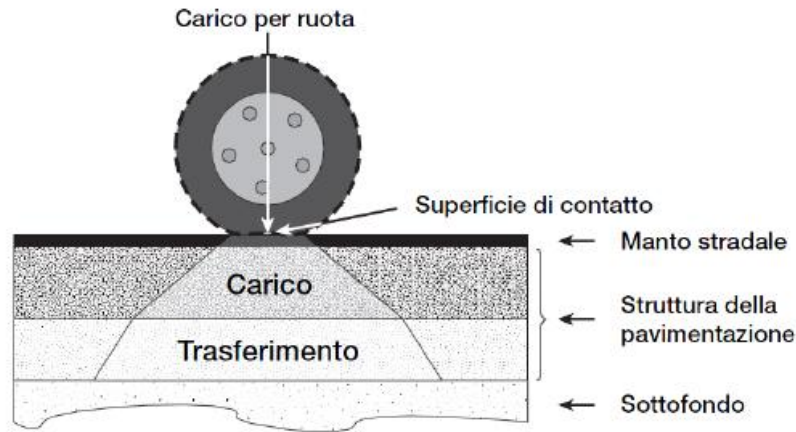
5: Trasferimento del carico tramite la struttura della pavimentazione stradale
